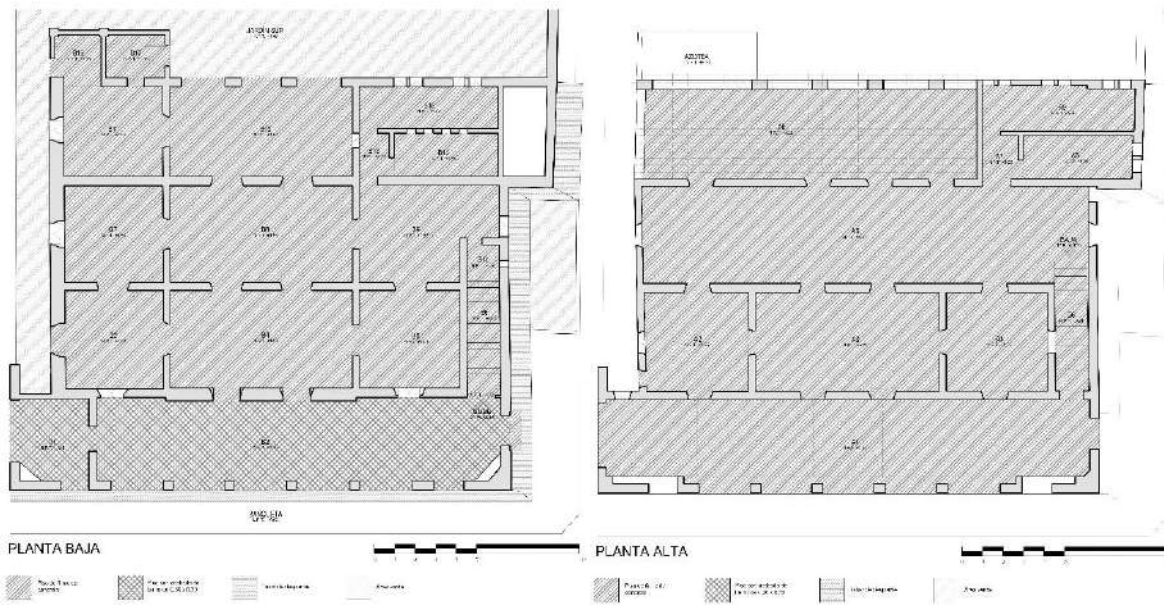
Plano de tipos de pisos en planta baja y planta alta del edificio Xculucya 2017. Fuente: Elaboración propia.
